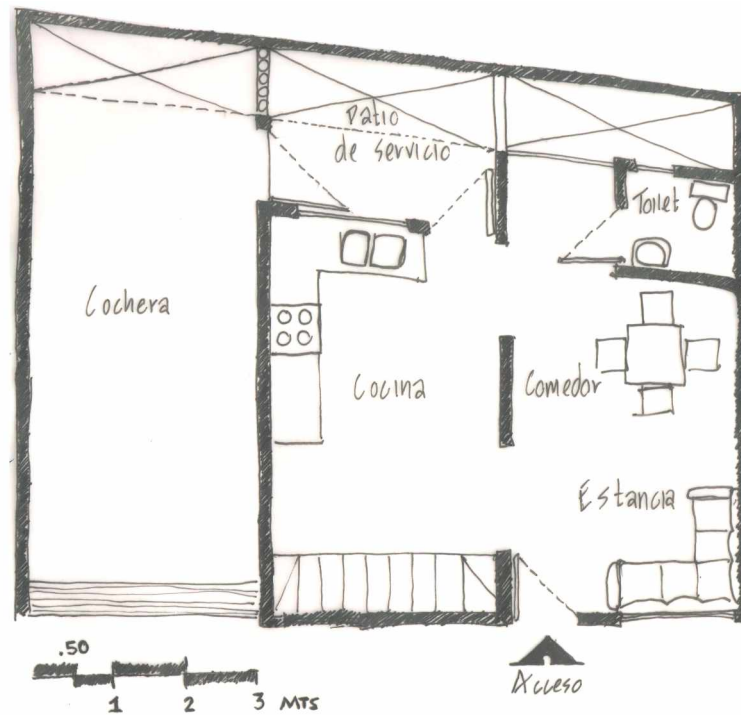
BOCETO DE VIVIENDA 3 CUARTOS PLANTA BAJA
